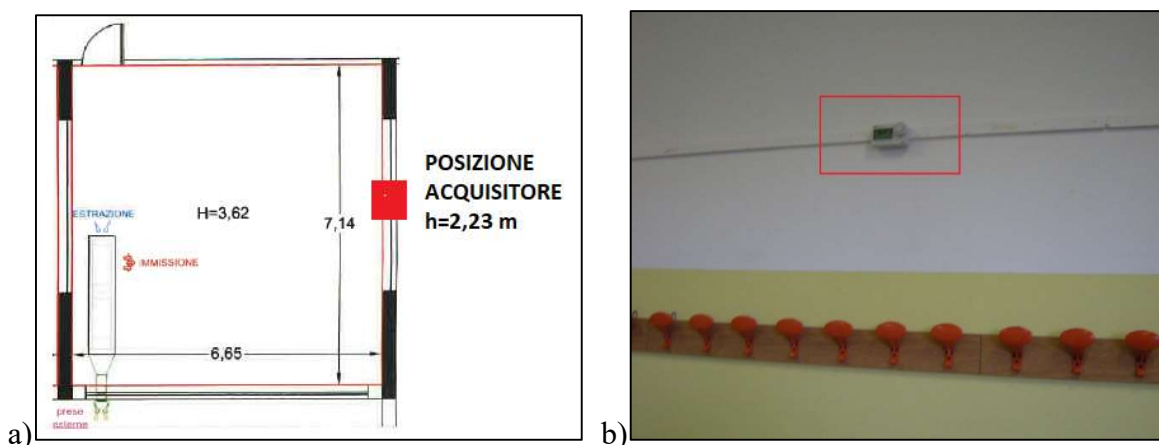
Posizione acquirente in pianta (a) e in foto (b)
